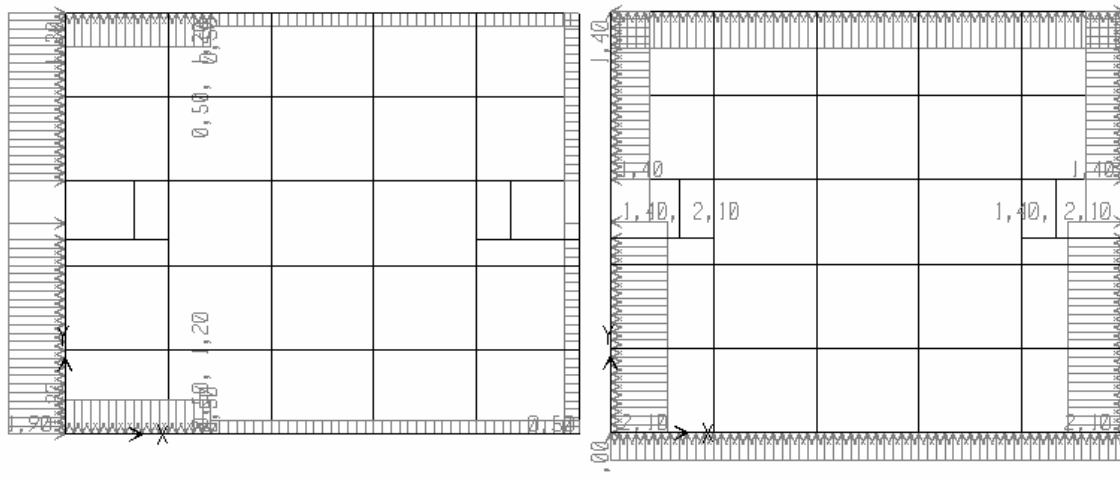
Carregamento de vento do 1° ao 4° pavimento nas direções x e y.
